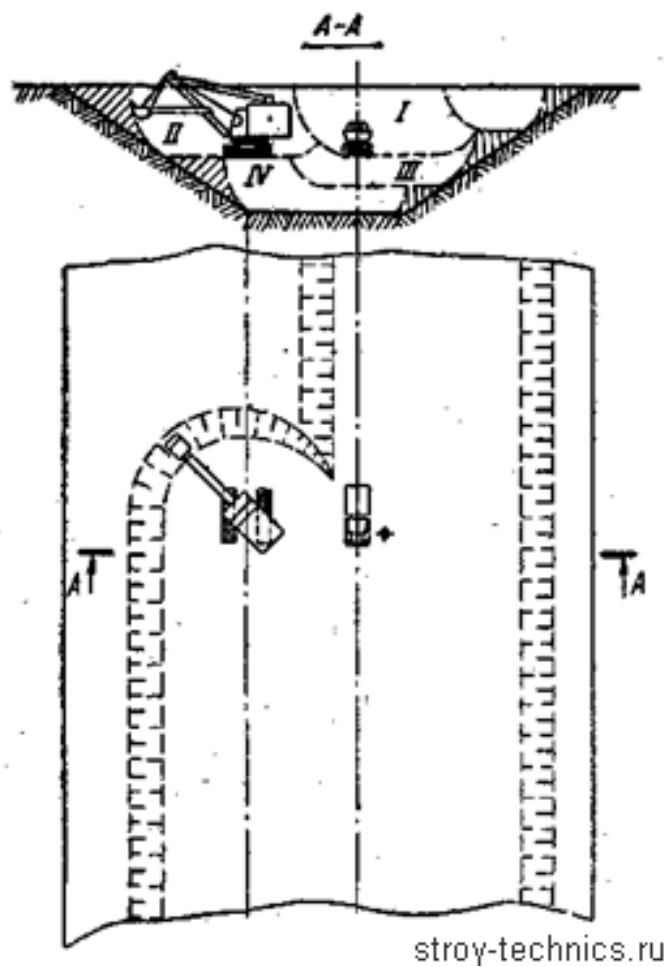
Схема разработки выемки уступами с погрузкой грунта в автосамосвалы:
